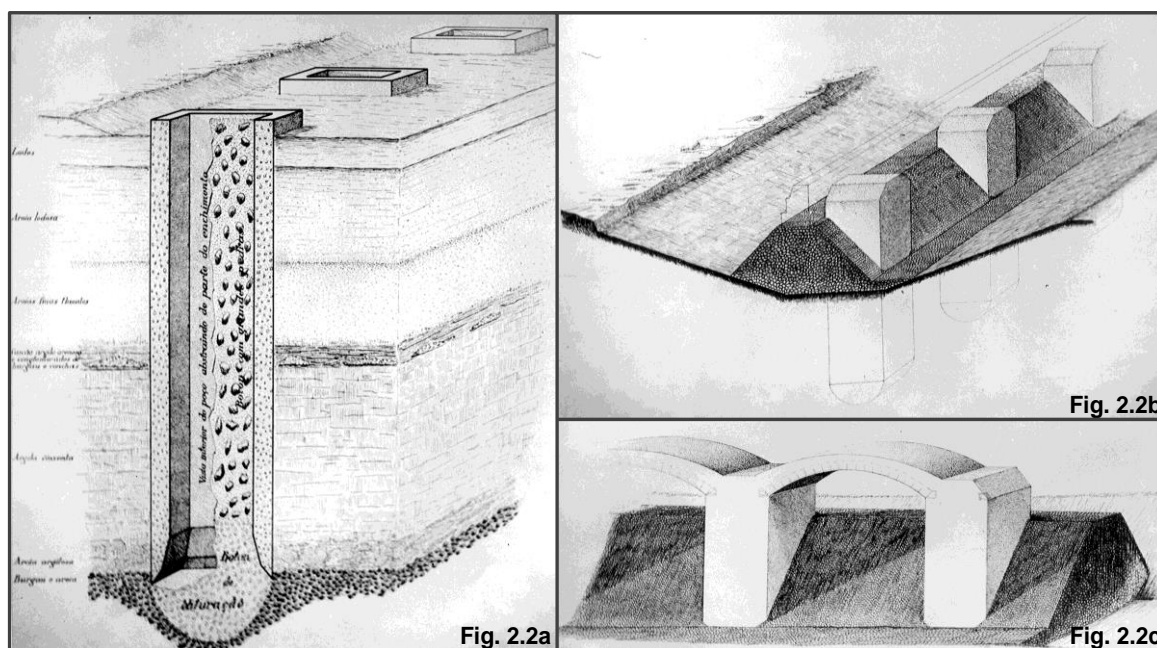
Desenhos do faseamento construtivo ilustrando as atividades chave da intervenção
